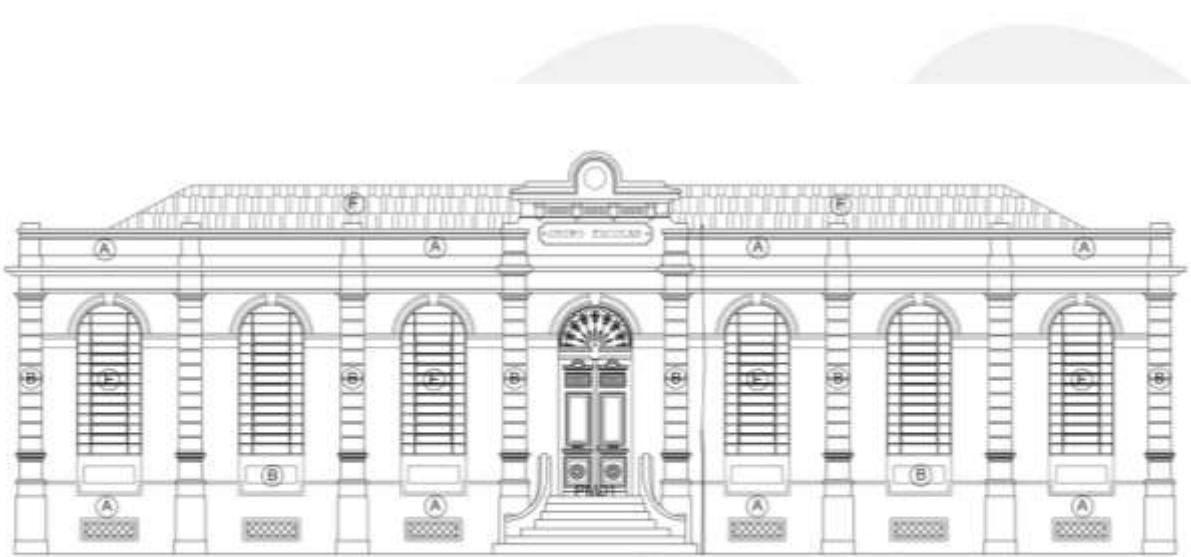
Fissuras devido o ataque de sais minerais
